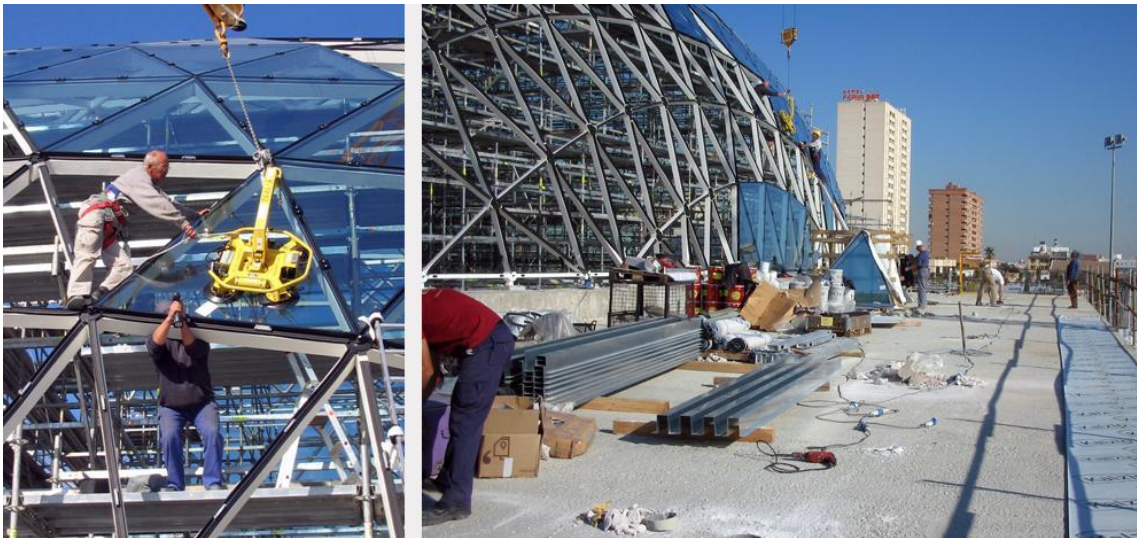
Instalación de los paneles de vidrio. Fotografía in situ.
